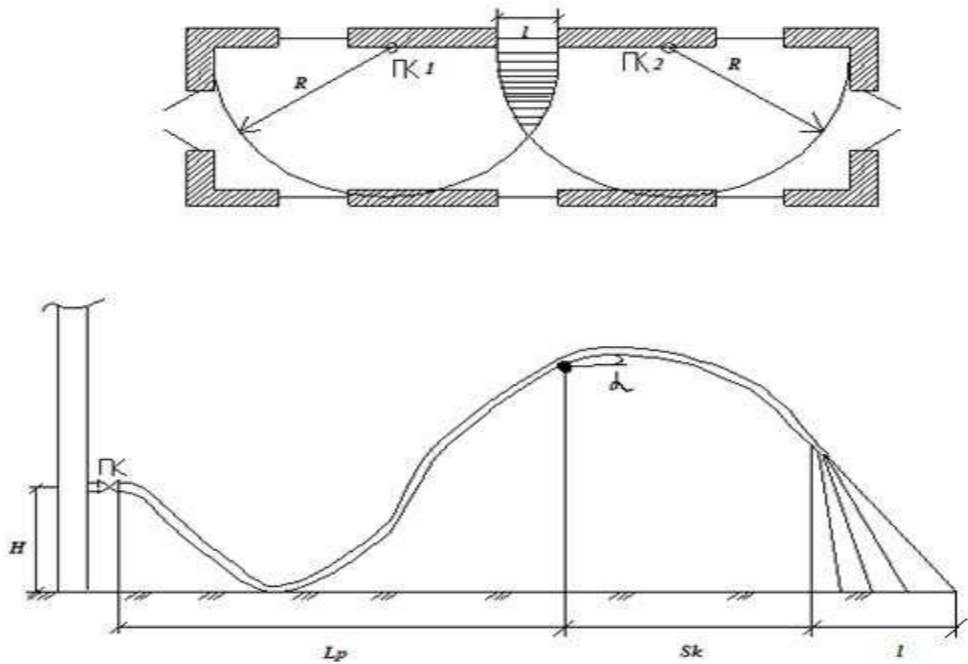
Зоны действия пожарных кранов внутри здания
